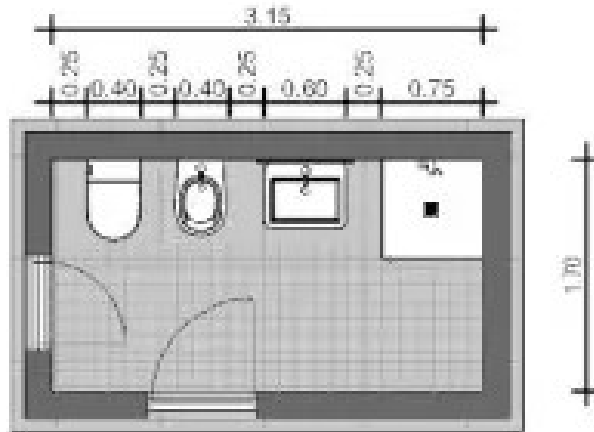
Schema planimetrico stanza da bagno tipo⁴⁴
